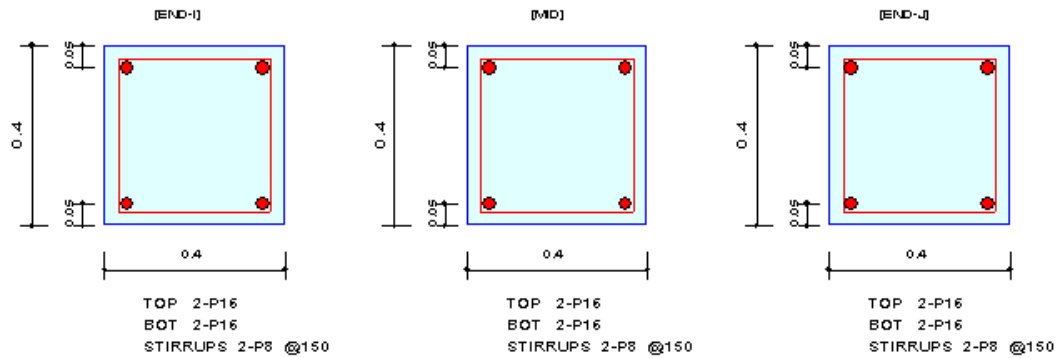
Schema verifica travi di fondazione SLU (elemento maggiormente sollecitato)
